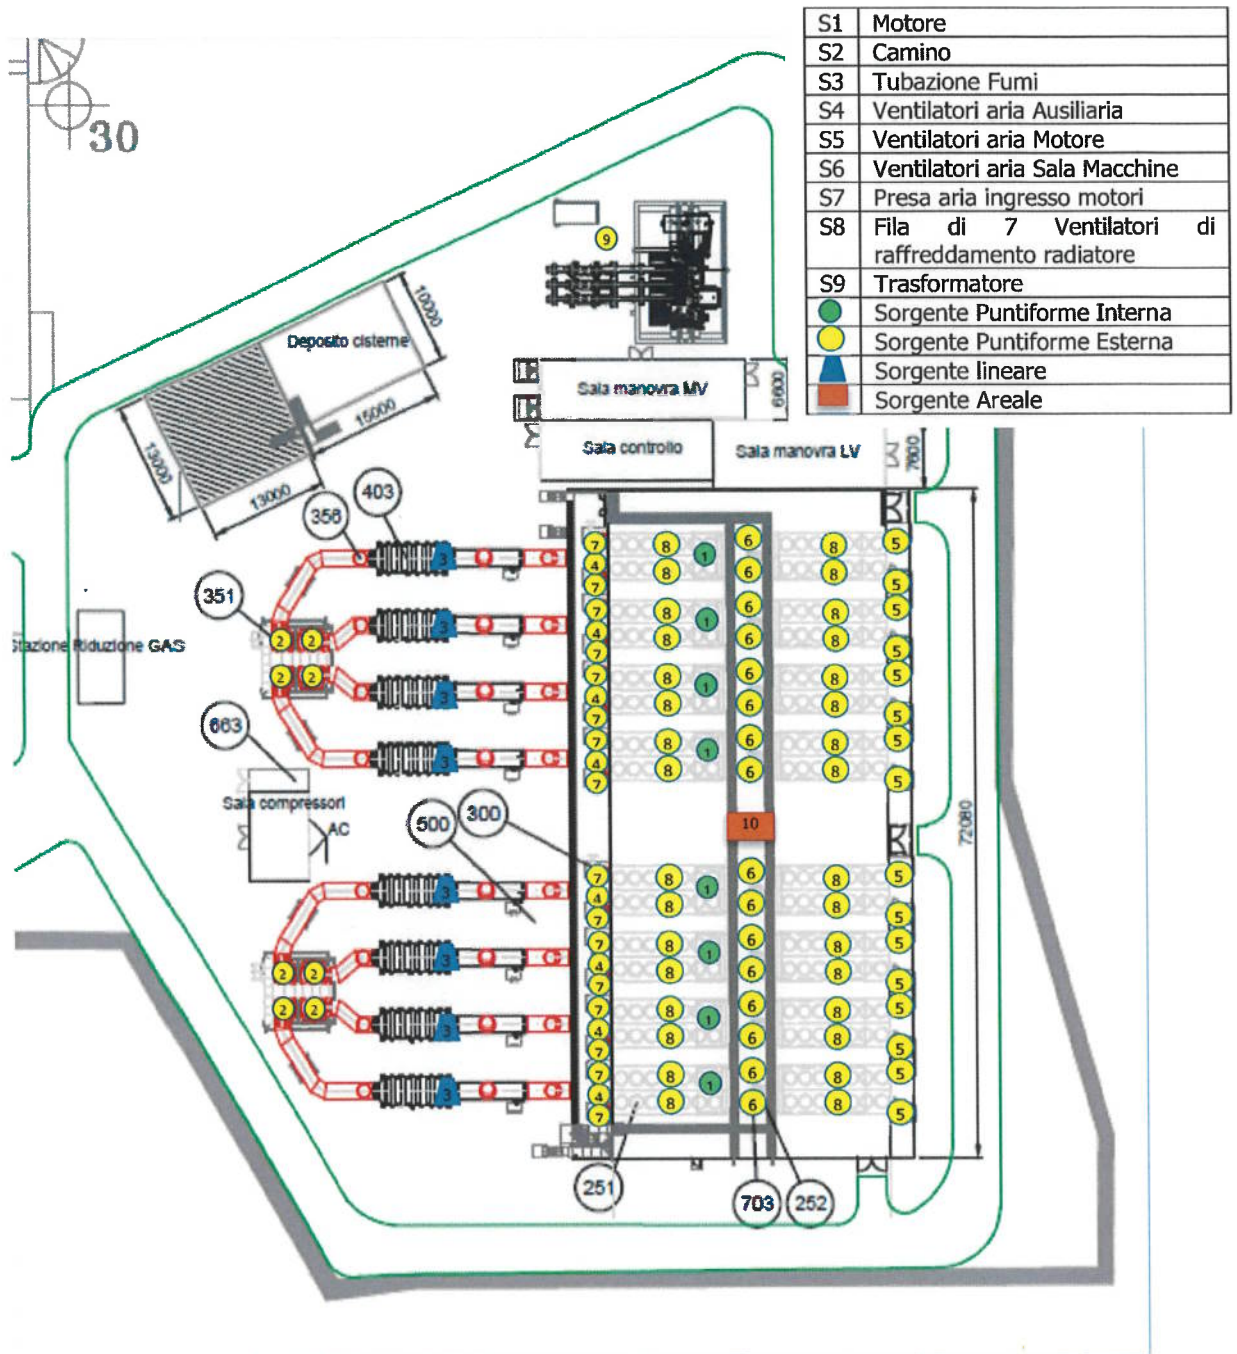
Planimetria con disposizione delle sorgenti sonore
